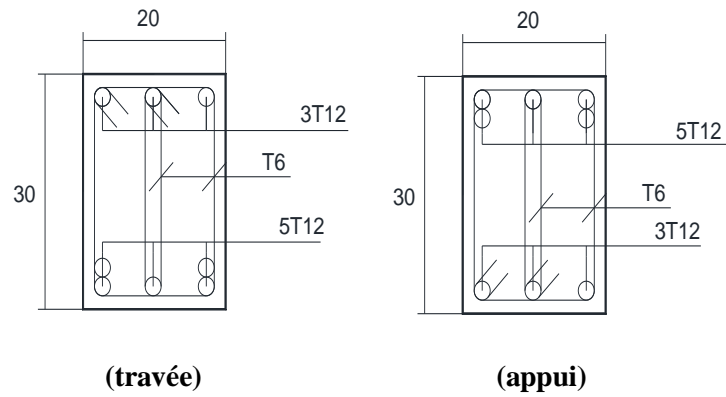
Ferrailage d'une poutre secondaire 20x30cm (plancher au dalles pleines)
